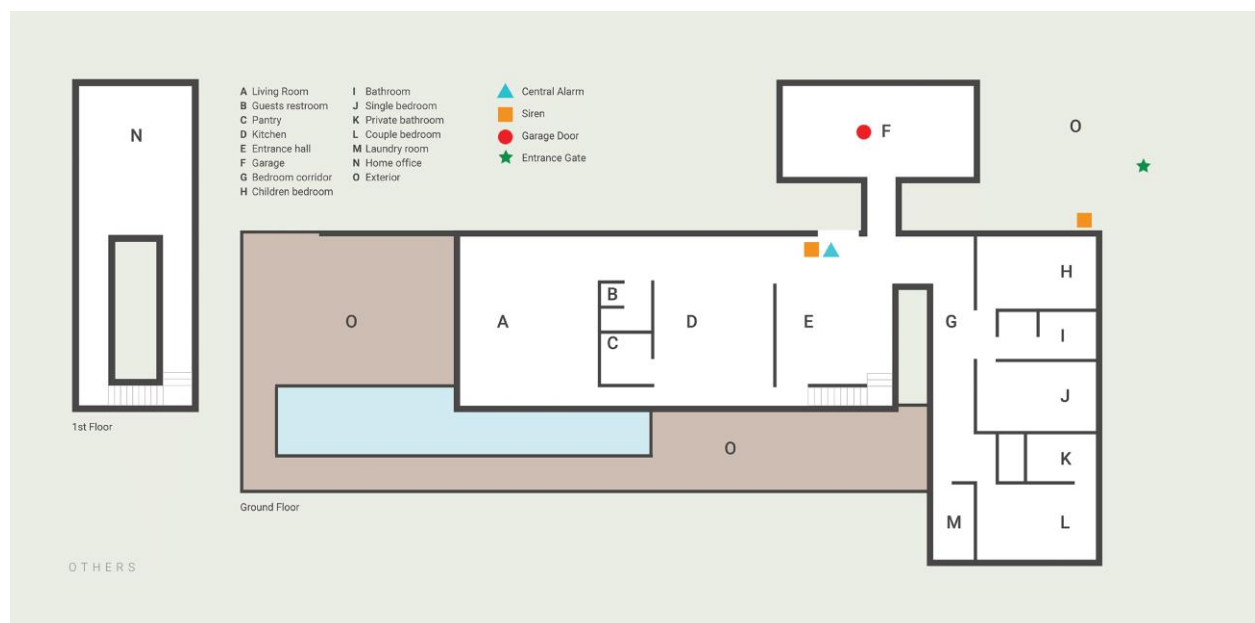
Plano de distribución de otros dispositivos automatizables de la vivienda
